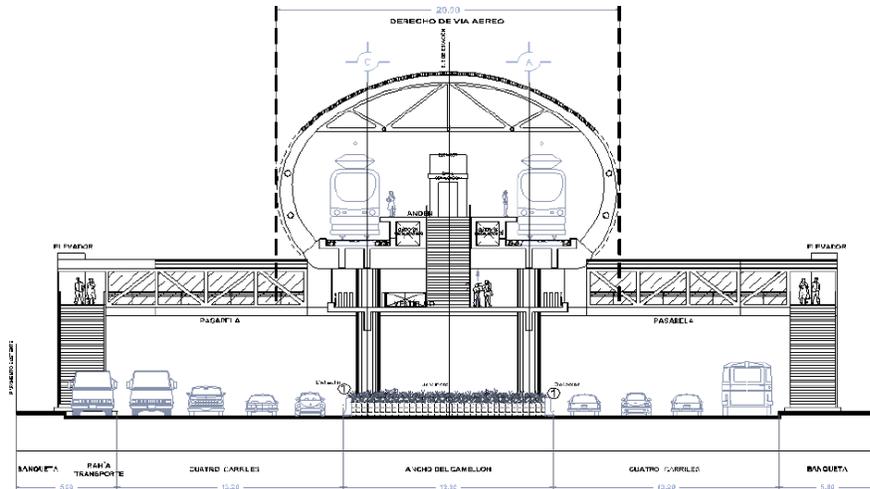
27. Sección de estación tipo elevada sobre el tramo Ermita – Iztapalapa.
